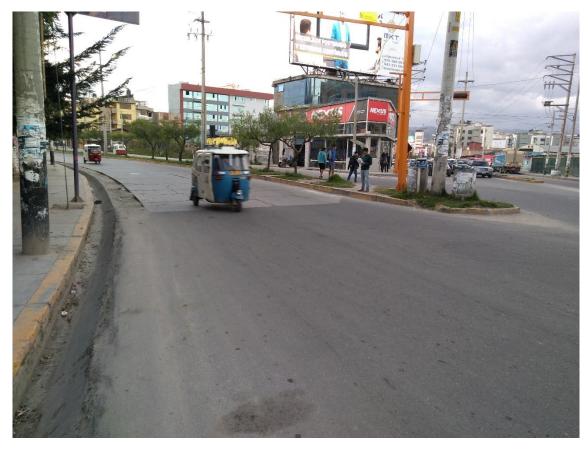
Vista de avenida Vía Evitamiento Norte de norte a sur
